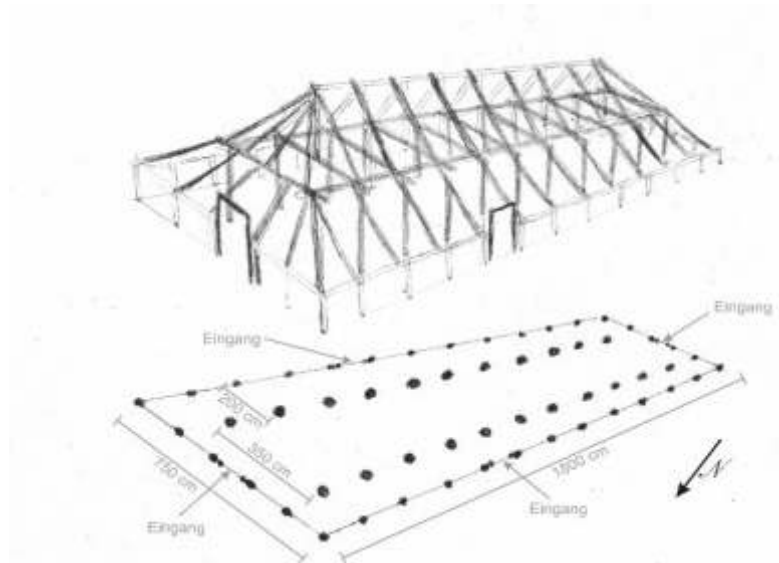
Erste Bauzeichnung für das geplante Langhaus
